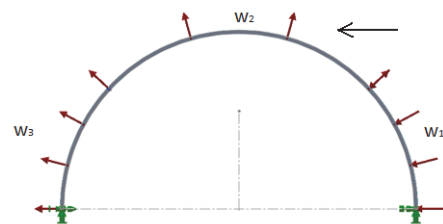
Схема расположения зон давления на свод: сечение 1–1 (рис. 12) [Figure 16. Layout of pressure zones on the roof: section 1–1 (Figure 12)]
